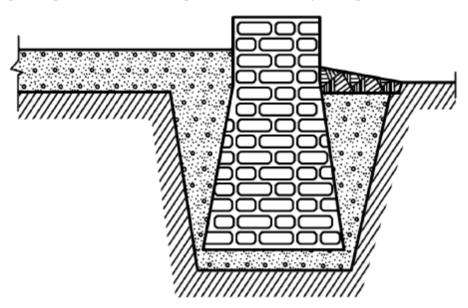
Устройство бутового фундамента на пучинистых грунтах
